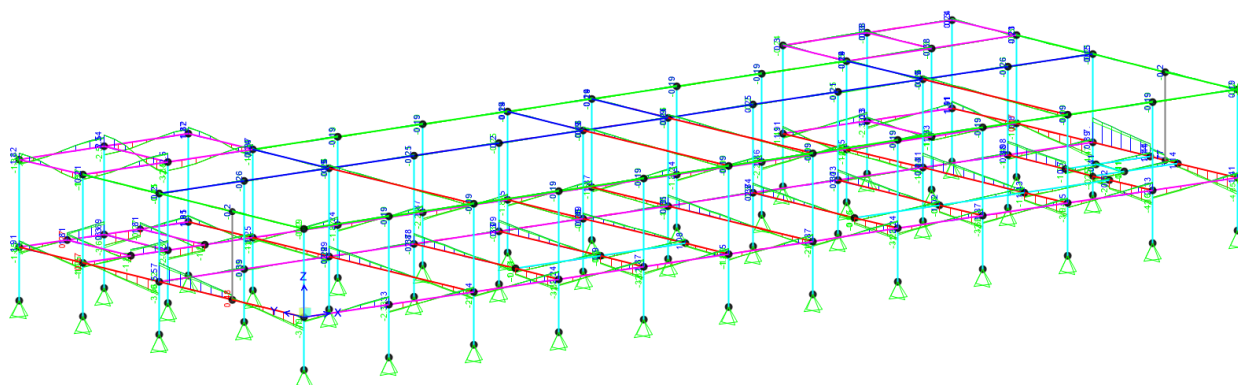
ESTRUCTURA DE HORMIGÓN | CORTE [Tonf]
